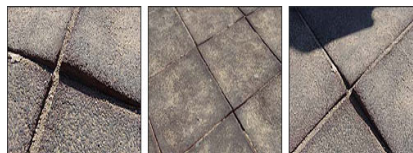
Pavimento sem conectores (FLG, 2007)
